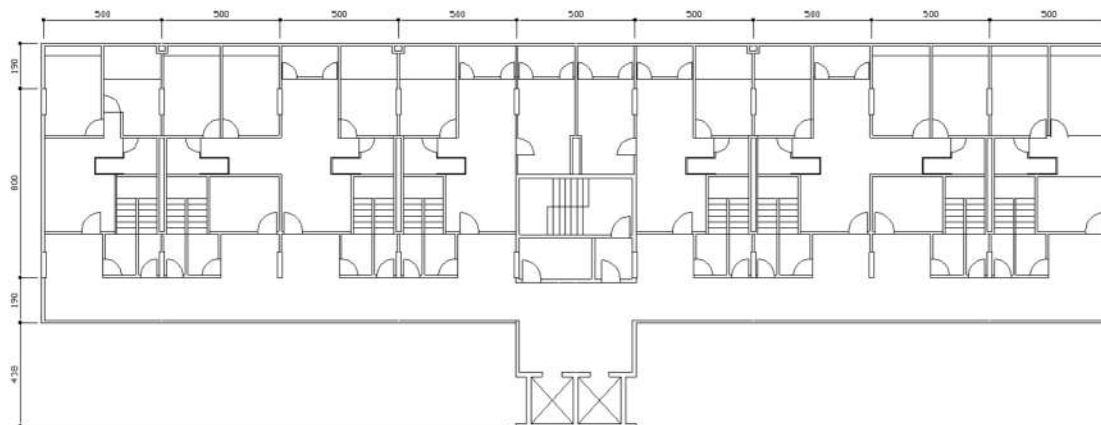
Planta de arquitetura do pavimento de circulação
